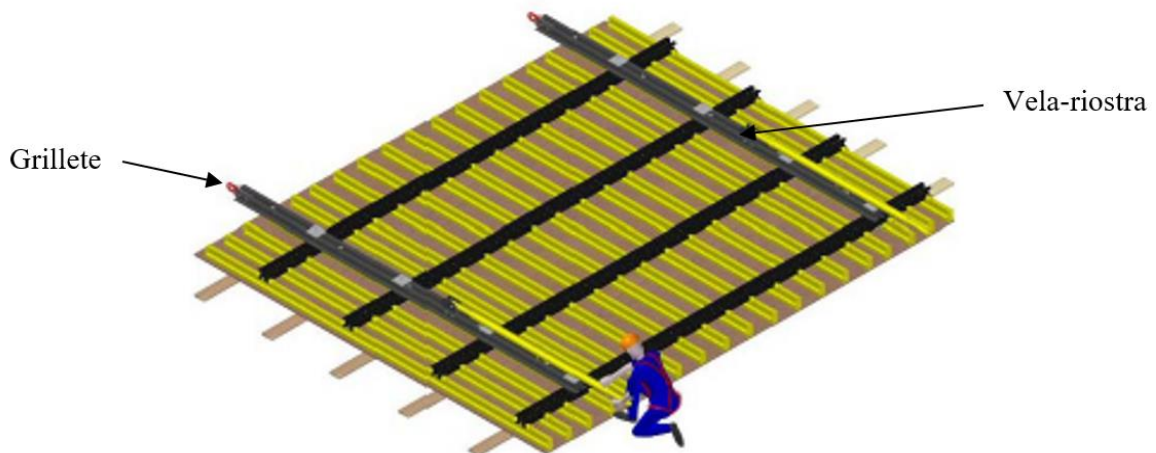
d. Colocación de vela y grillete. Adaptada de: Ulma Construction, *Instrucción técnica de montaje.
